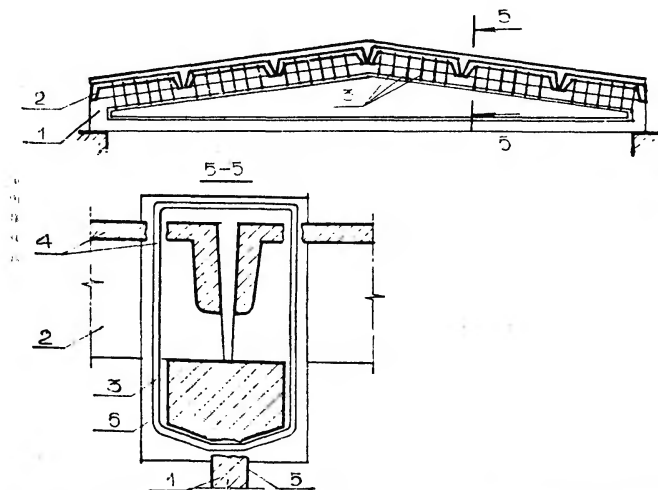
Включение в совместную работу плит покрытия путем устройства железобетонных обойм
